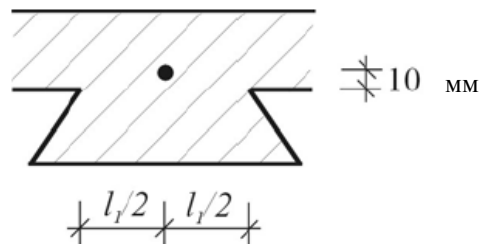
Расположение арматурных стержней в железобетонном перекрытии.
